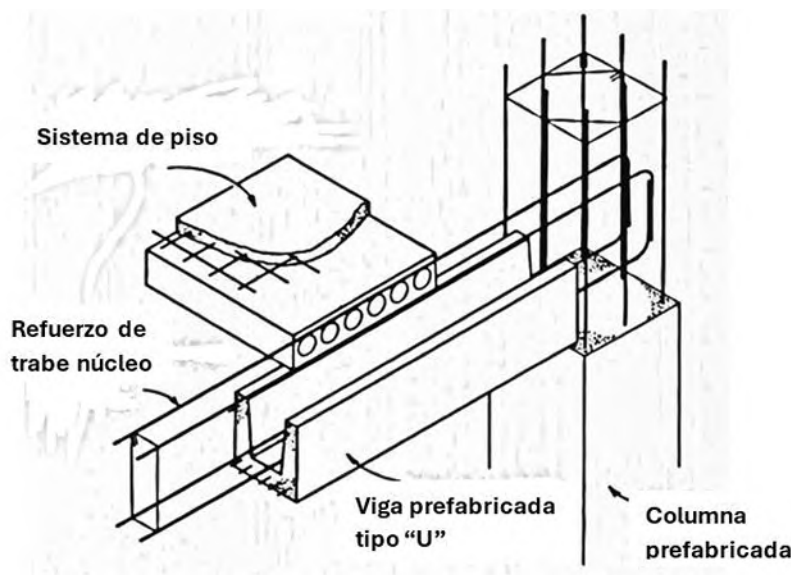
Detalle de conexión emulativa viga-columna prefabricada, (imagen adaptada de Park y col., 1986)
